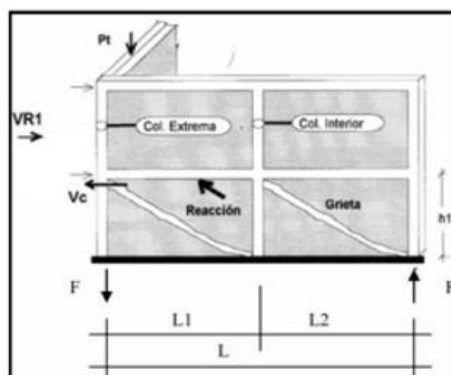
Fuerzas internas en columnas de un muro de albañilería confinada de un solo paño en voladizo. (San Bartolomé, 2004).
